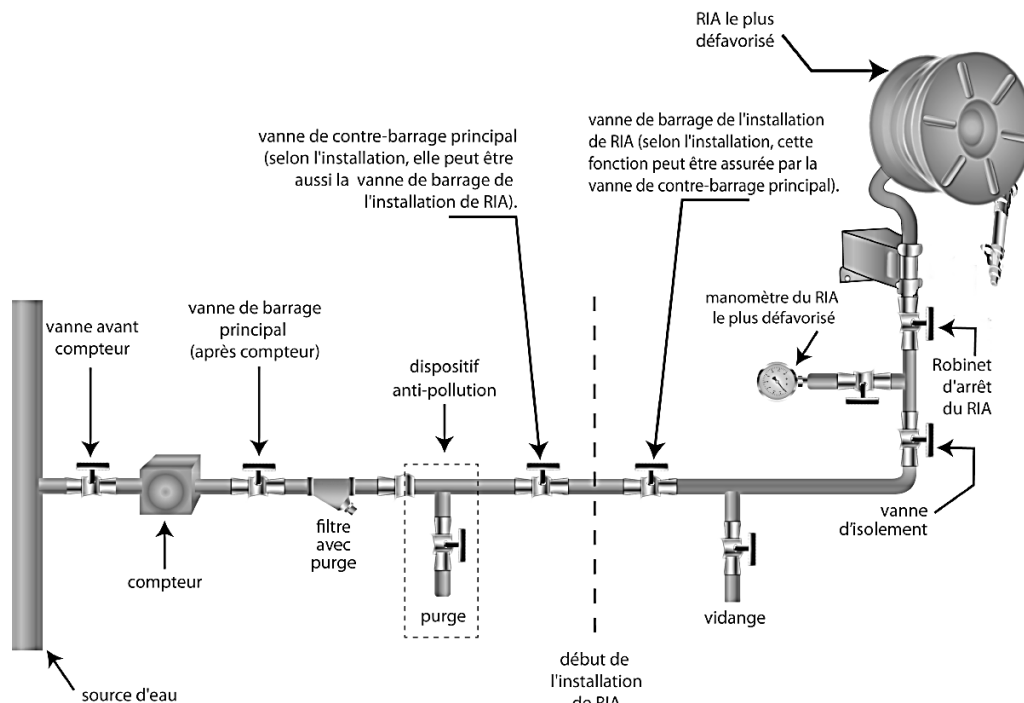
Exemple de raccordement d'une installation de RIA sur un réseau d'eau public
